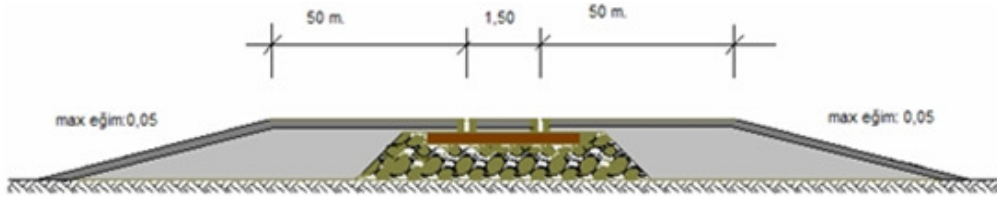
Beton prefabrik Kaplamalı Geçit
